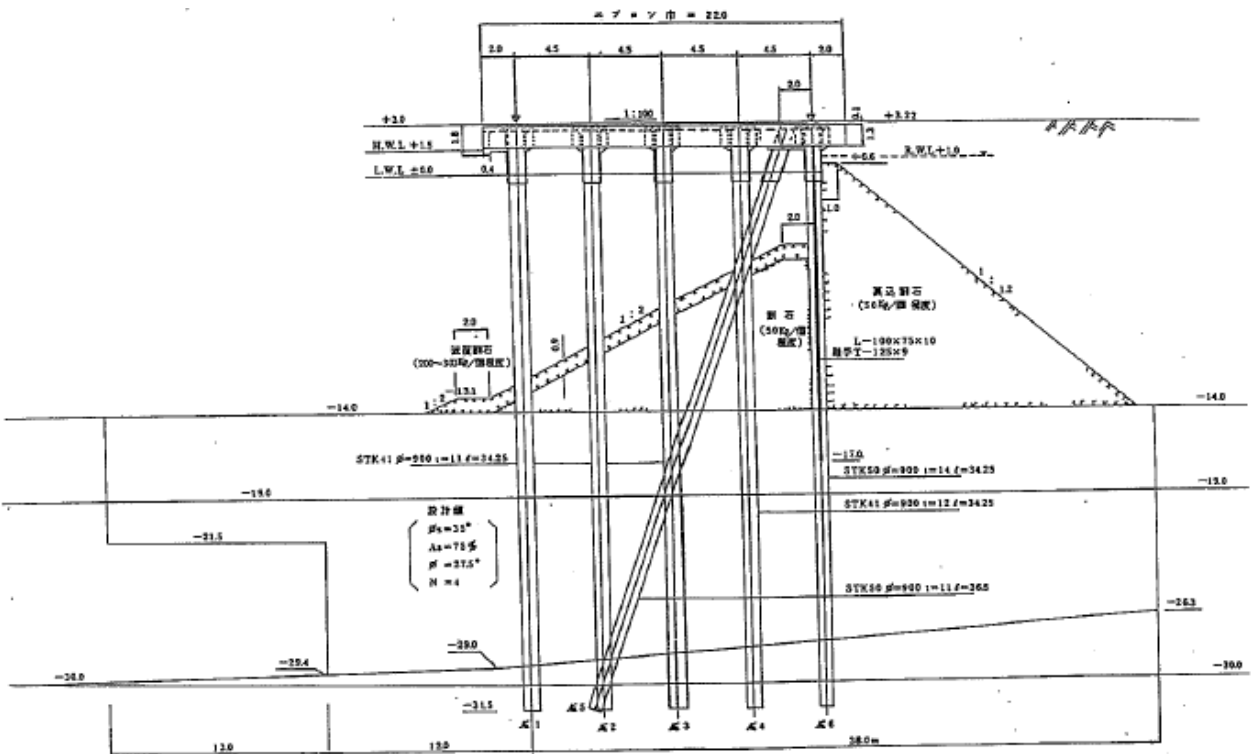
野々田地区栈橋 (-13m) の標準断面図
